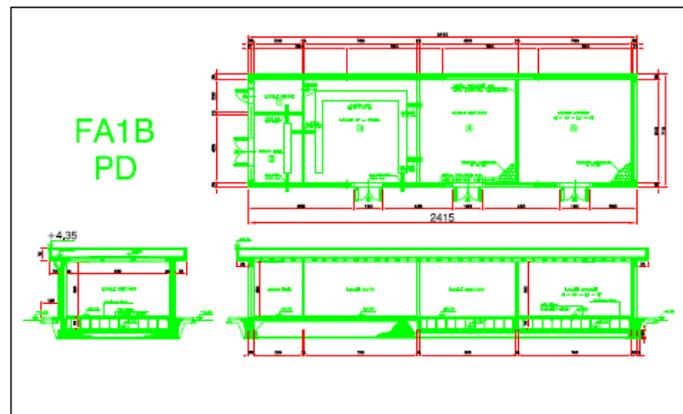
Schema planimetrico e sezioni della soluzione di PD
